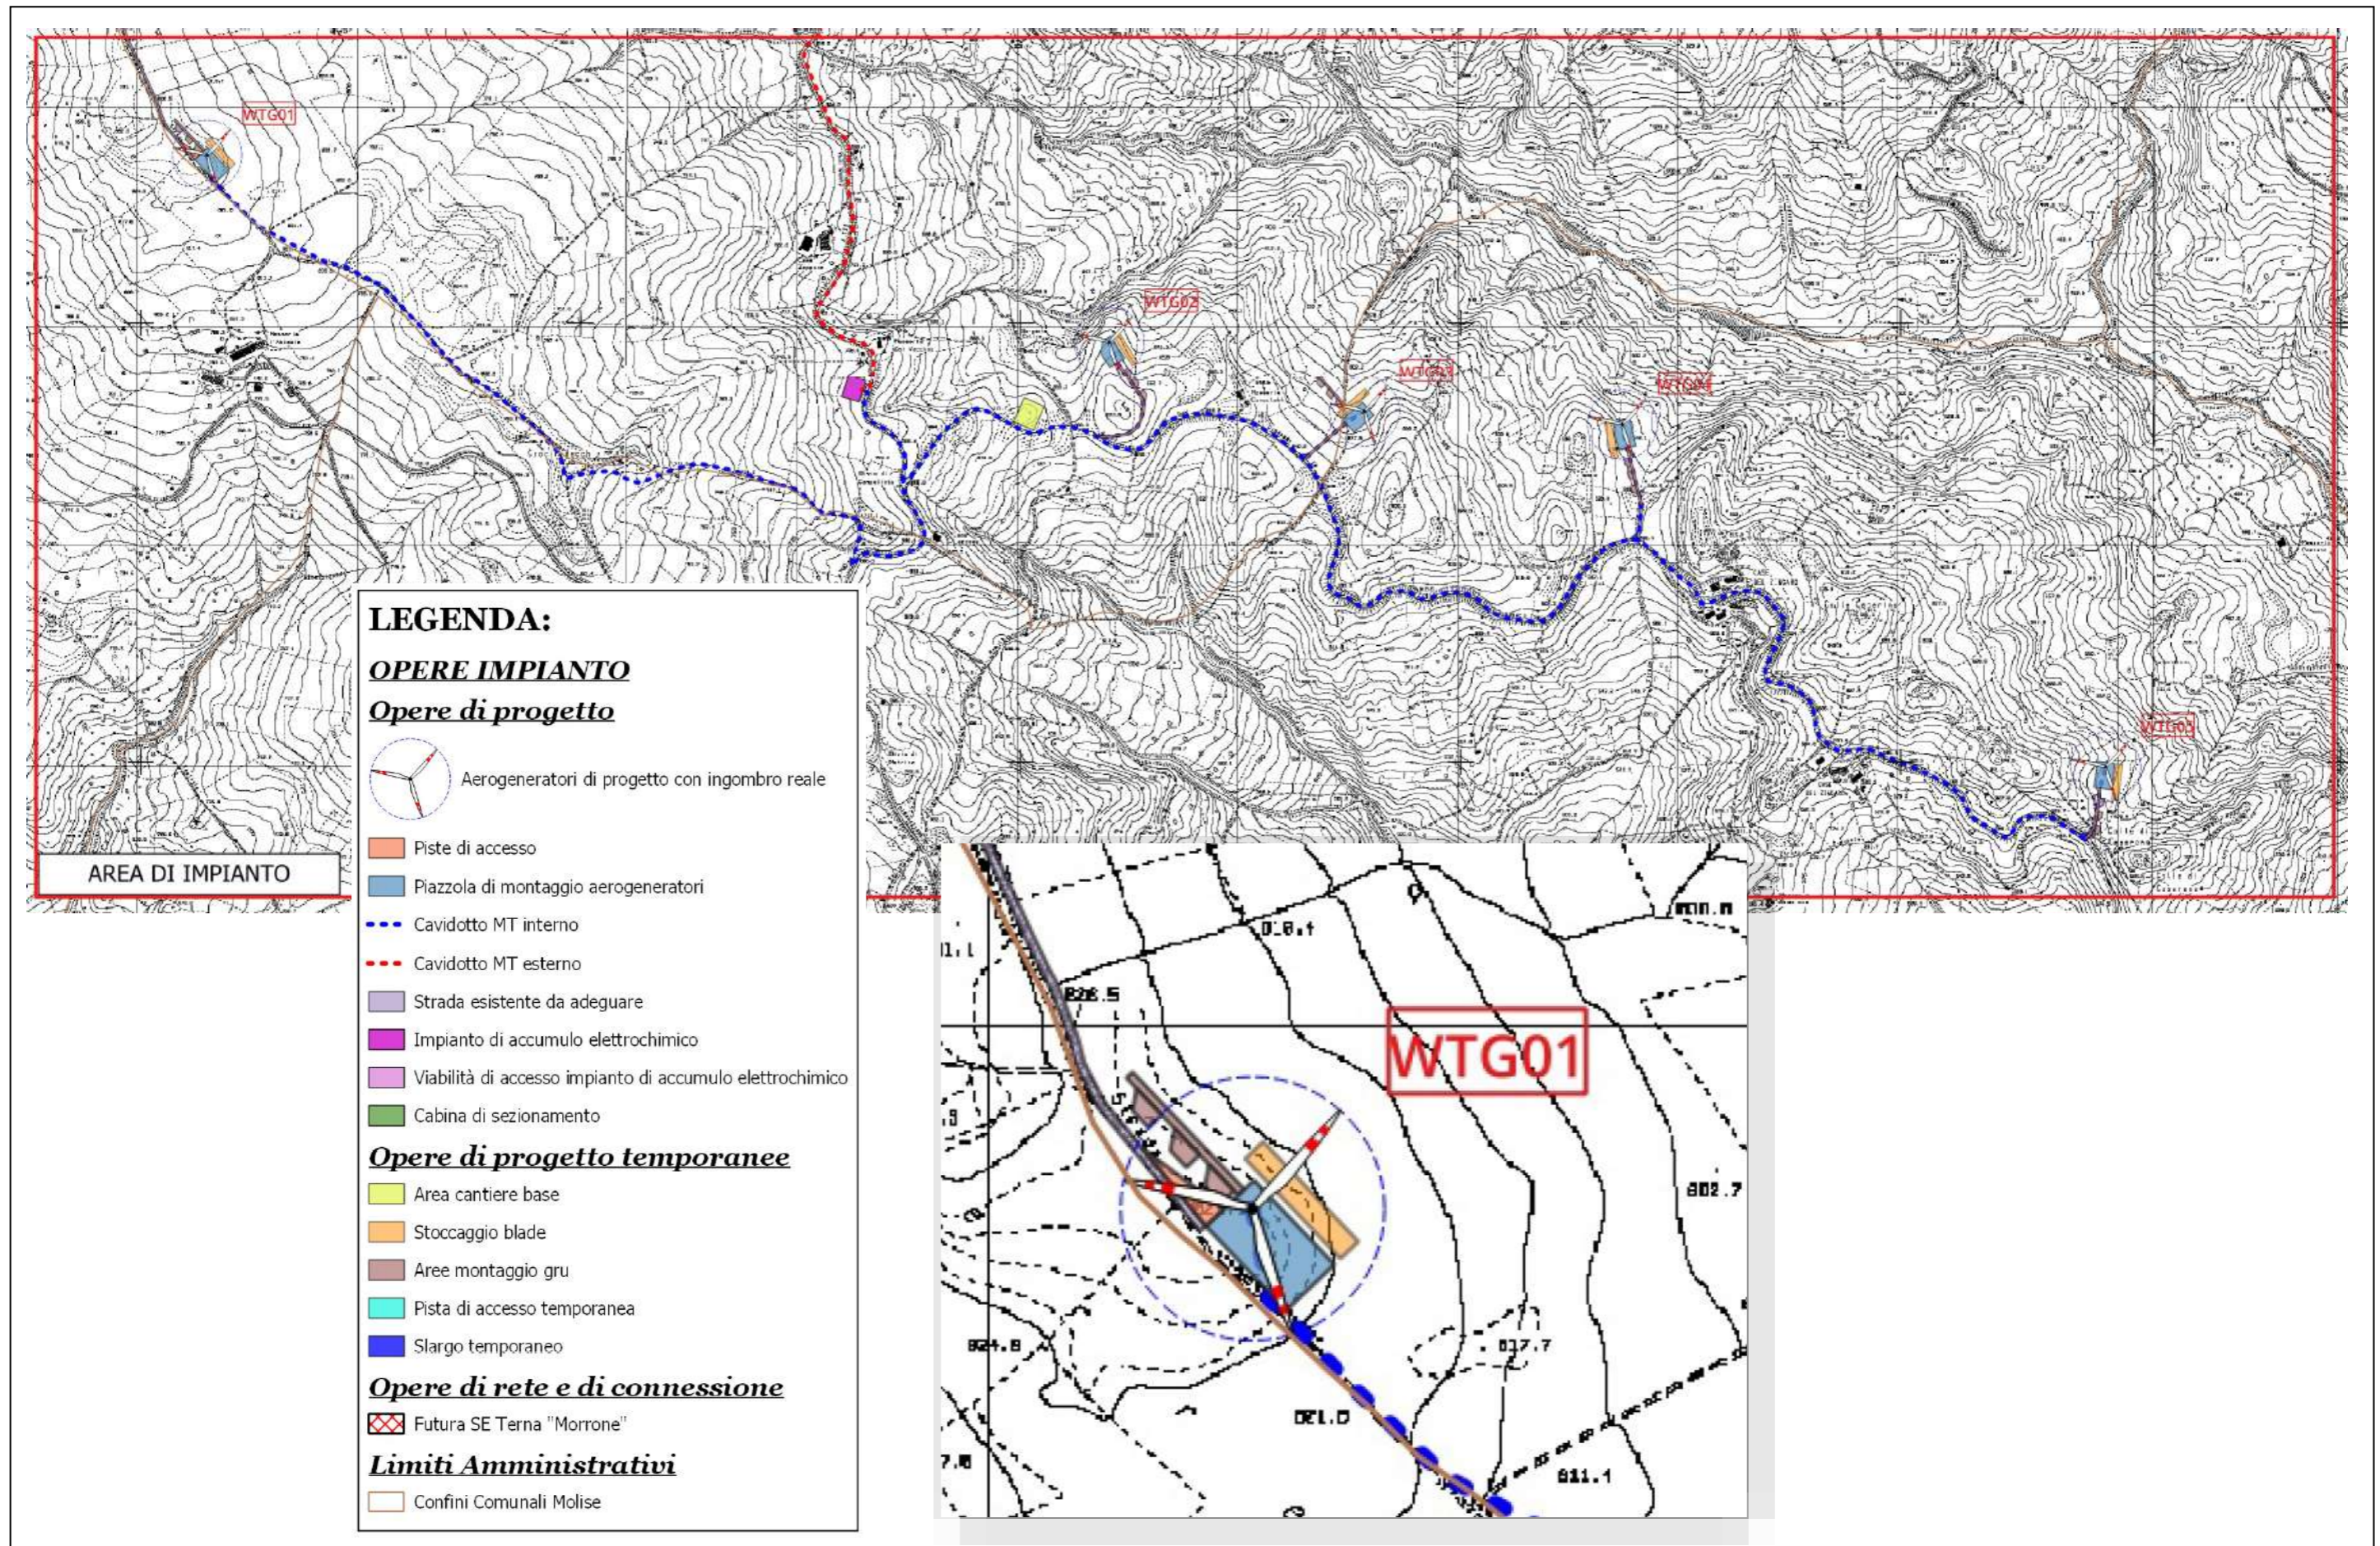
Stralcio Layout di progetto con particolare su aerogeneratore
